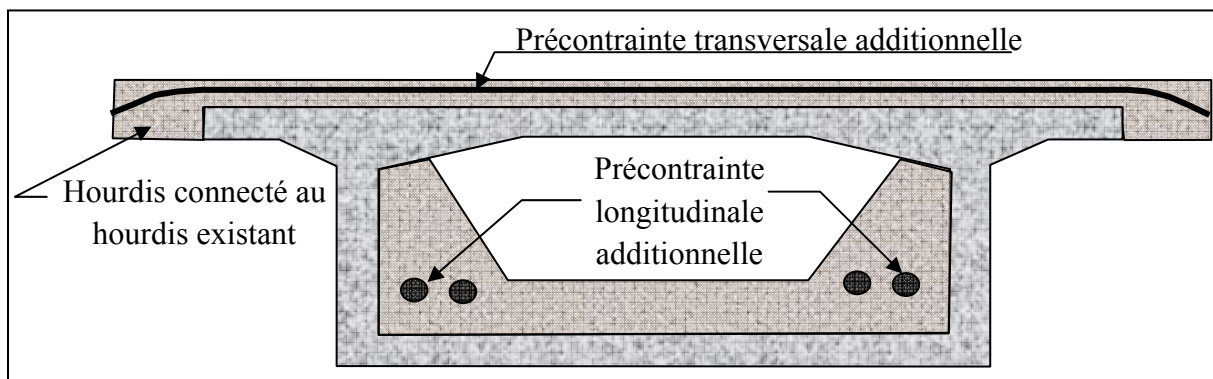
Élargissement de la dalle de couverture d'une poutre-caisson
